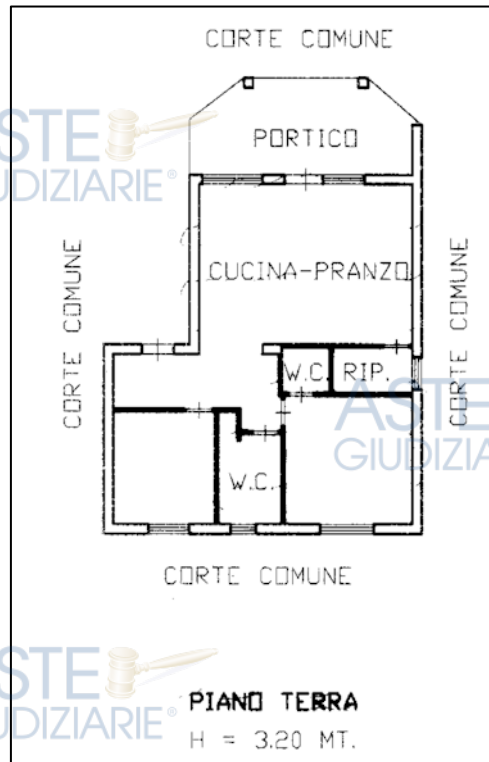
Estratto planimetria catastale (ALLEGATO 4)
